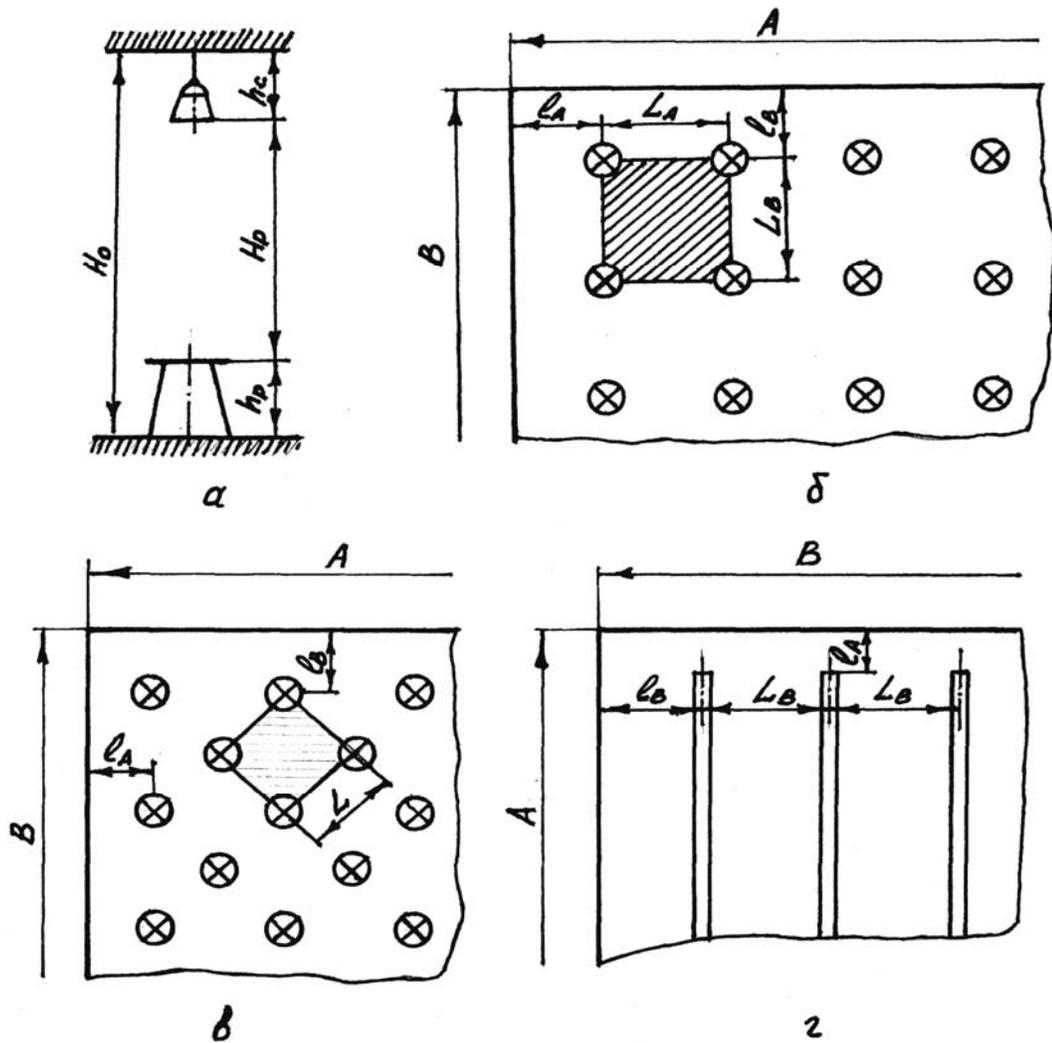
Варианты размещения светильников: а) в разрезе; б, в, г) в плане помещения; б) по углам прямоугольников; в) по вершинам ромба; г) в линию
